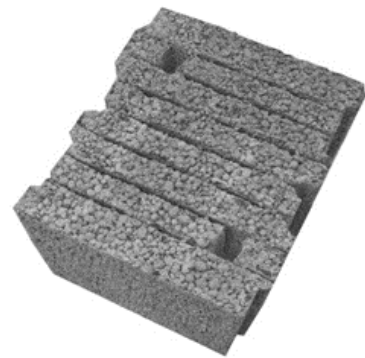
Beispiele zu Leichtbetonmauerwerk
